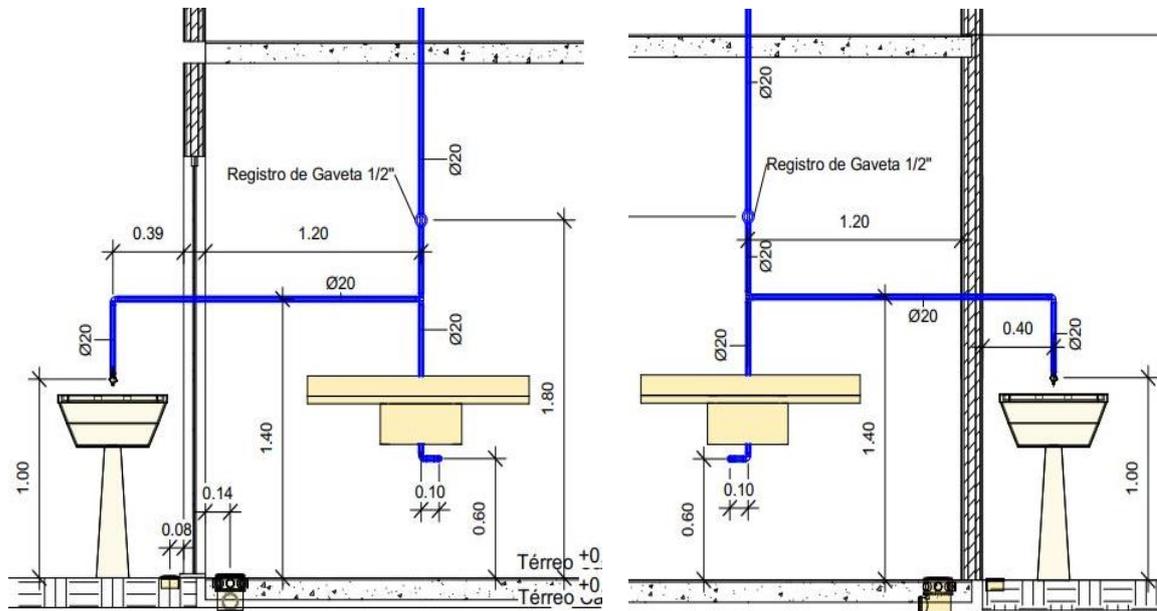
Instalação hidráulica Casa 1 e 4 em corte, banheiros, desenvolvido no software Revit.
